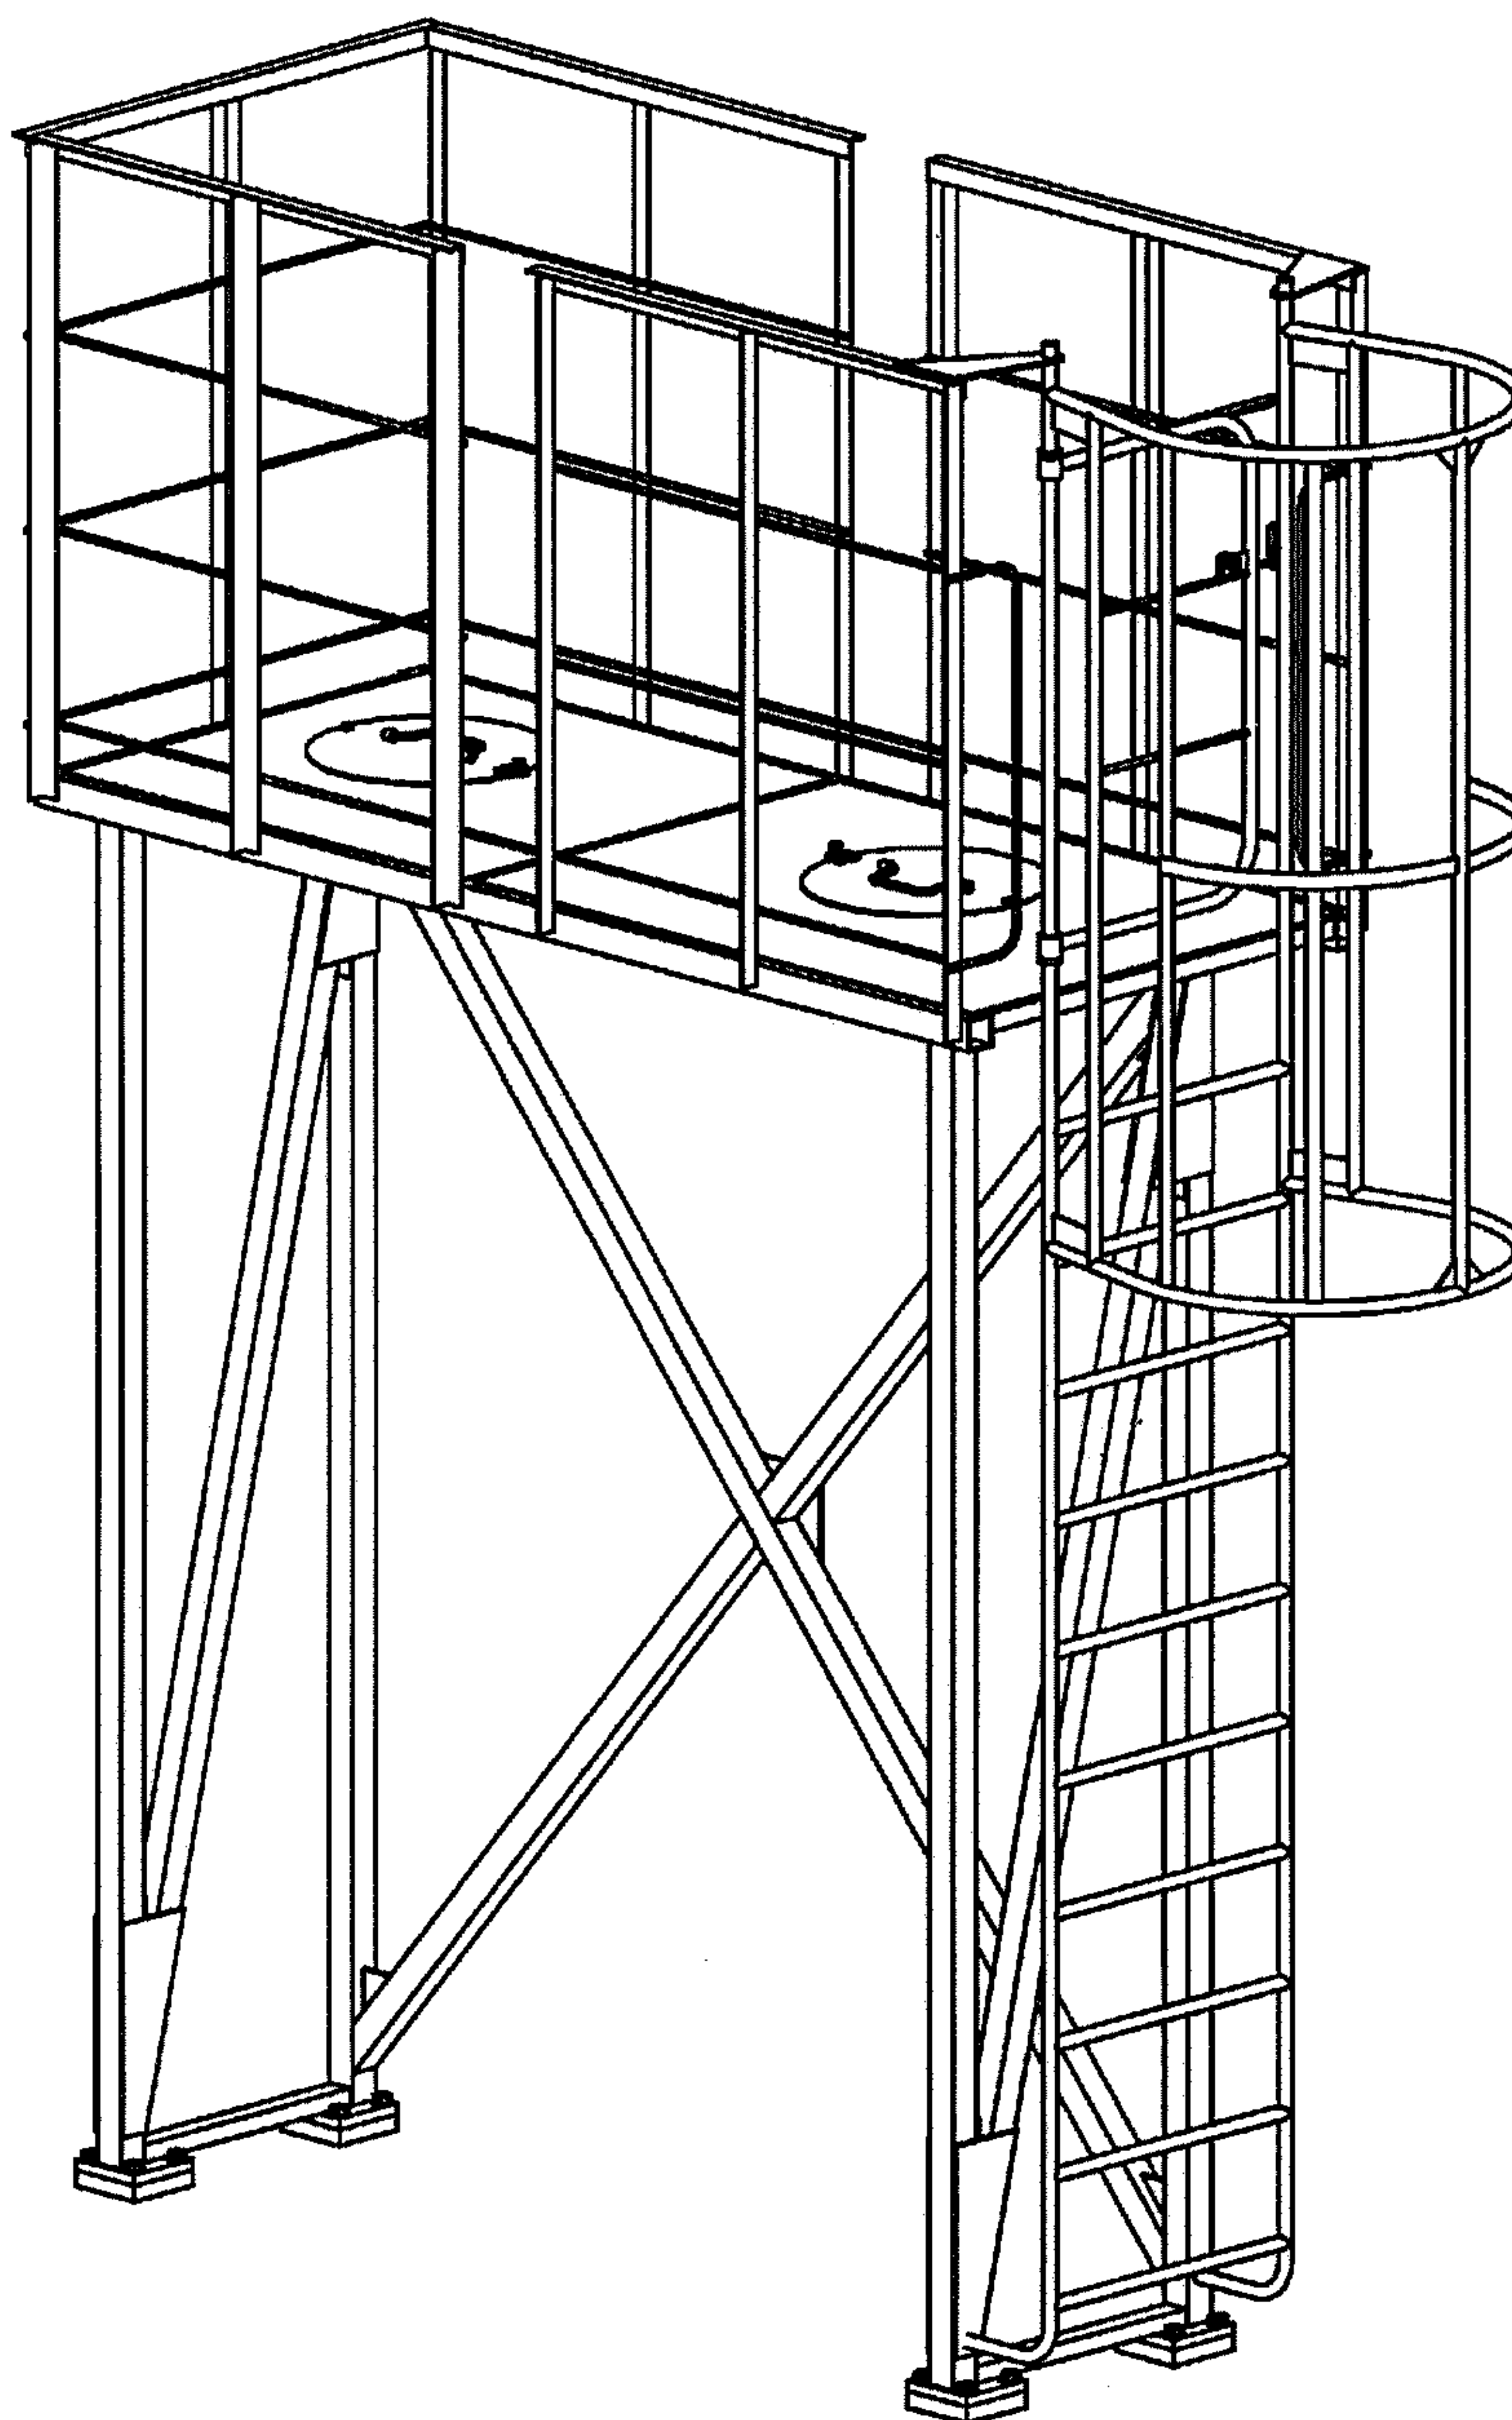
Площадка обслуживания стенда вертикального
